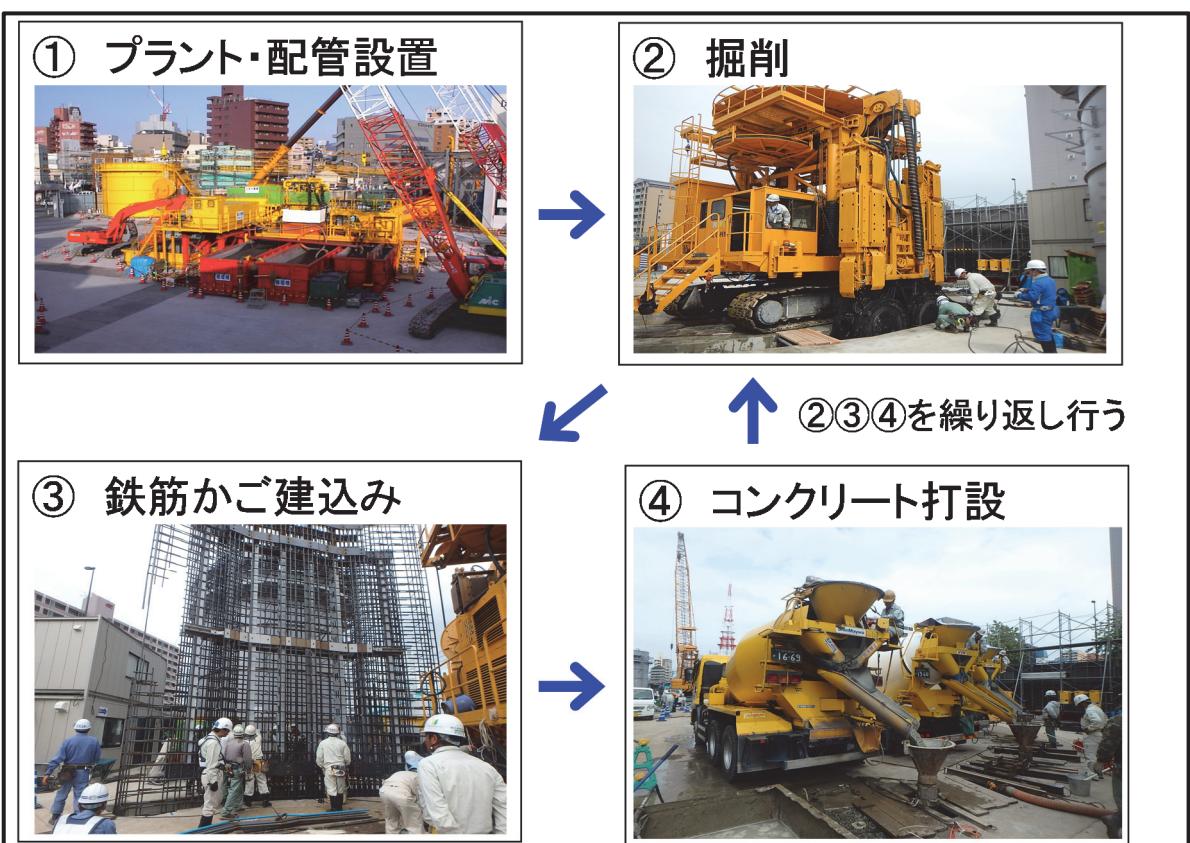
(2) 地中連続壁工の施工手順（写真は類似工事の例）
